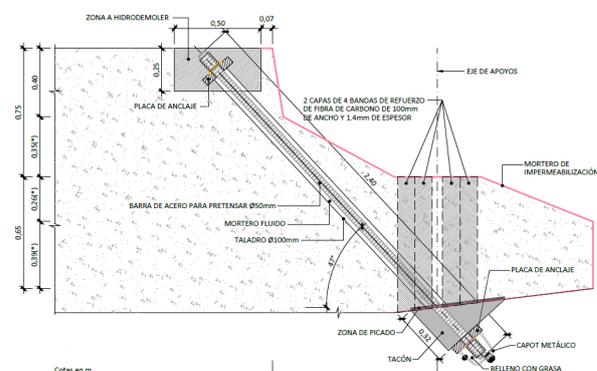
Esquema del refuerzo ejecutado en las medias maderas de la estructura
